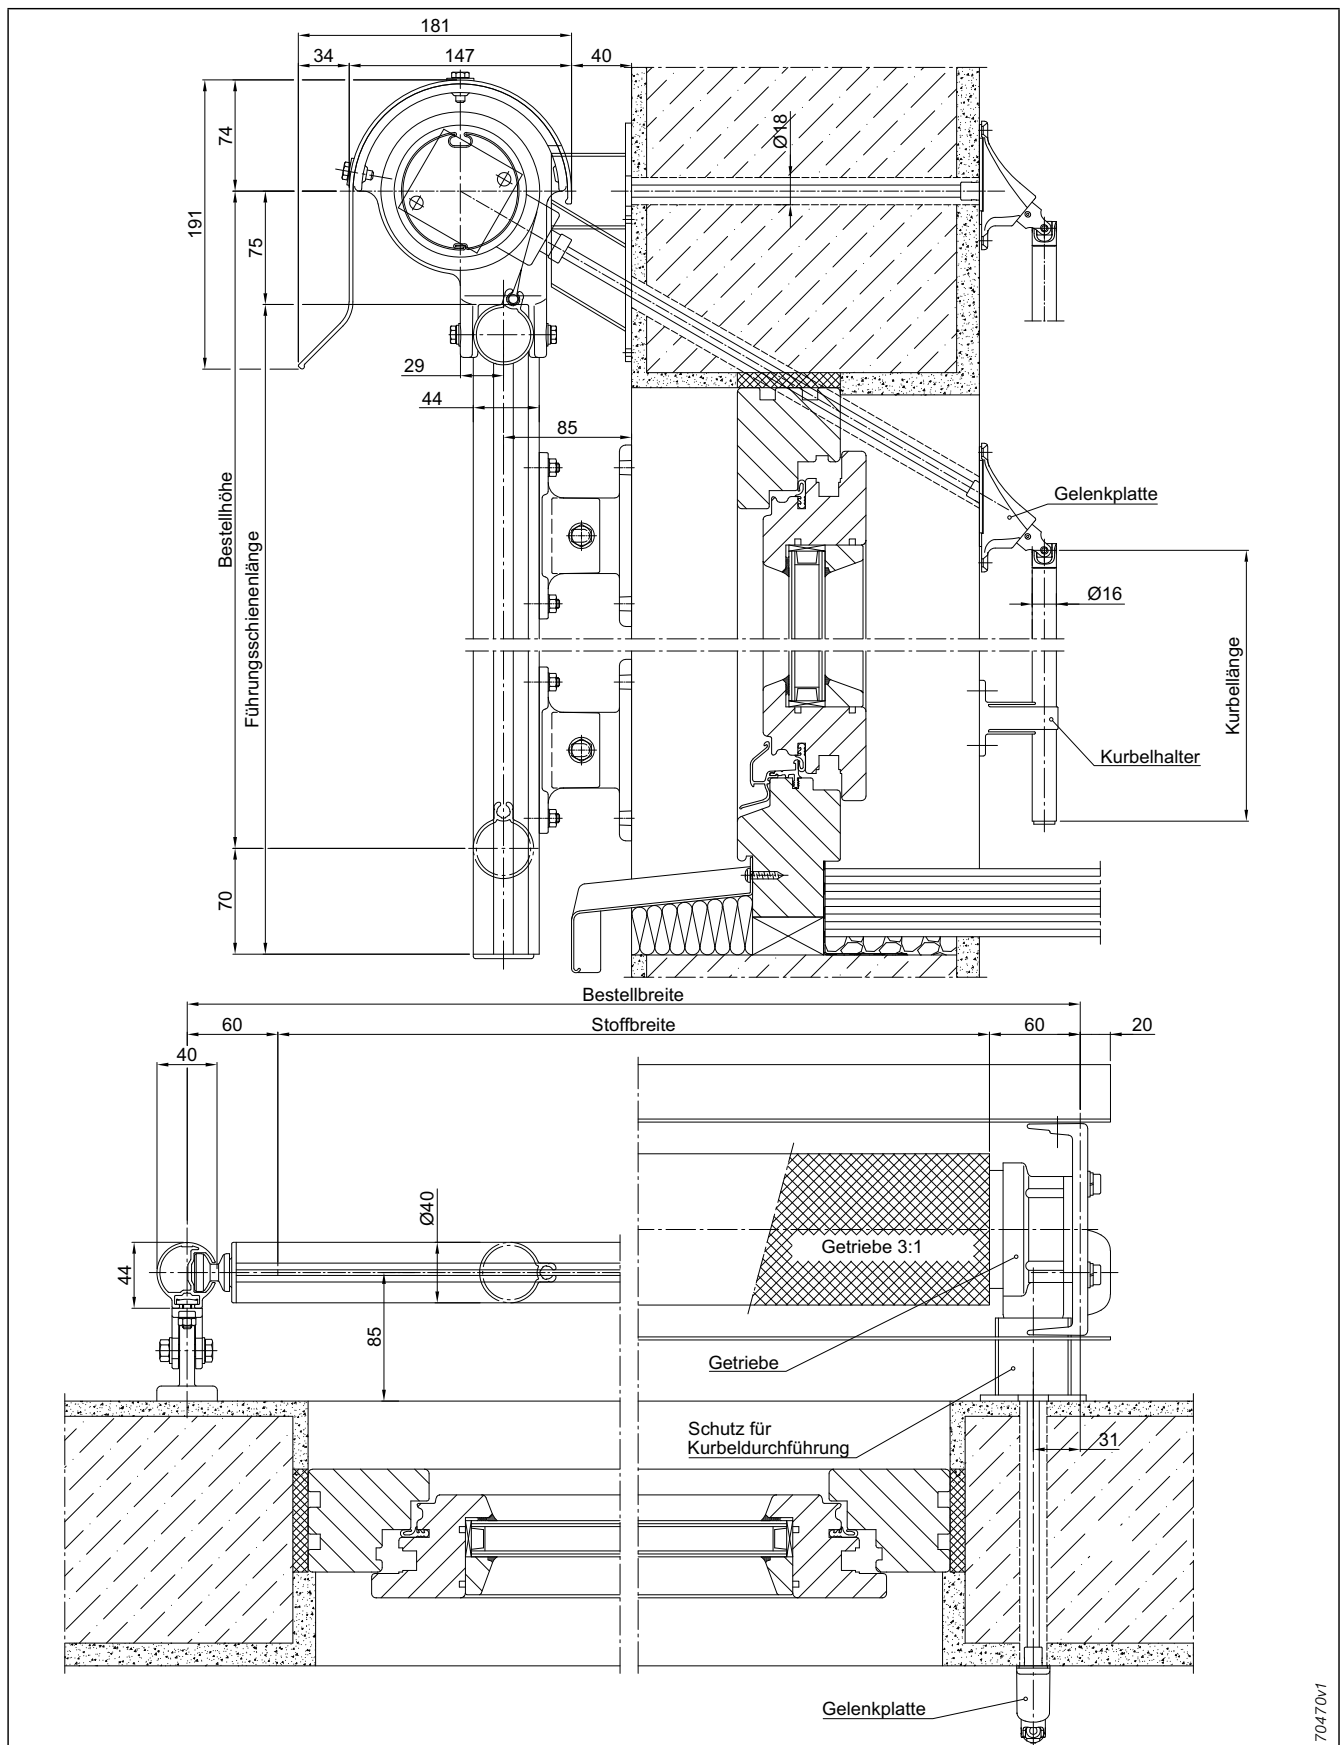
Fassaden-Markise 201 mit Halbrundblende Typ 2.3; Kurbelantrieb
